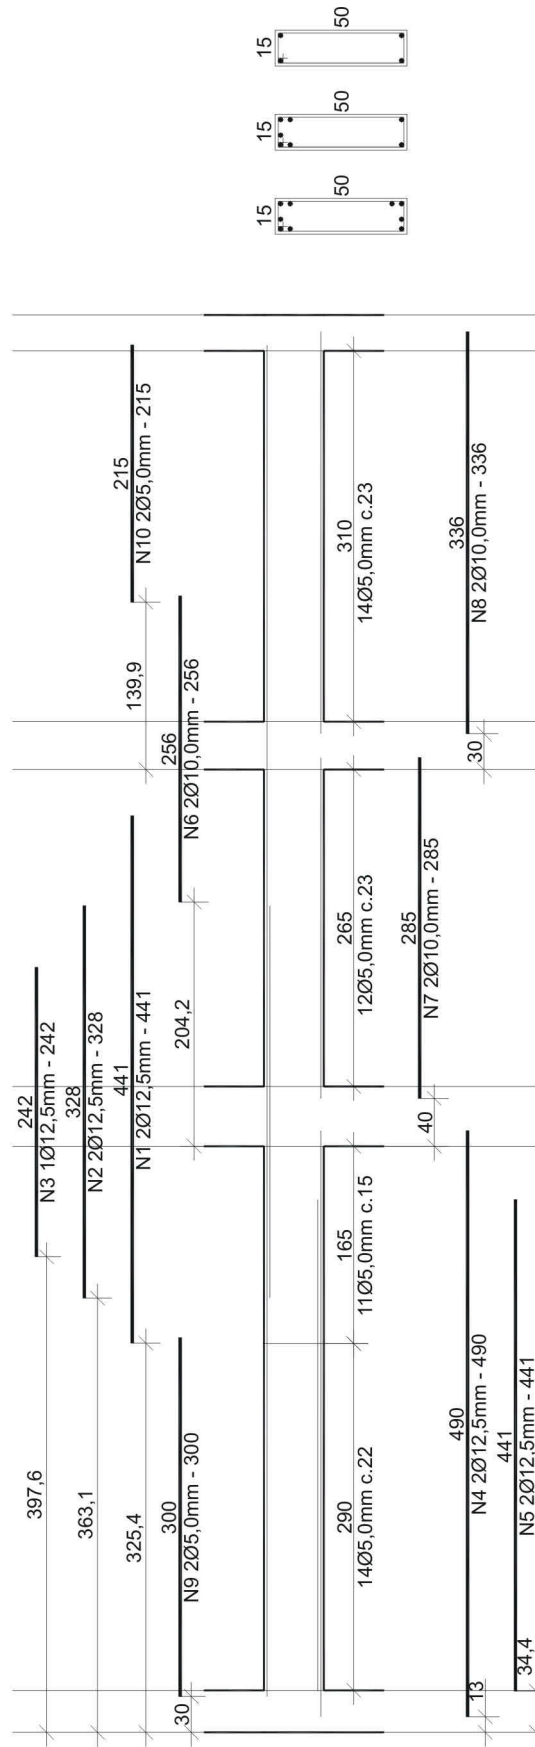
Detalhamento Viga 04.3, realizado pelo VigaCalc.
